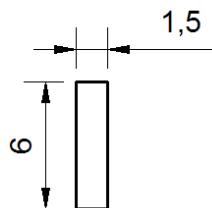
Penampang melintang girder 1 dalam cm.
